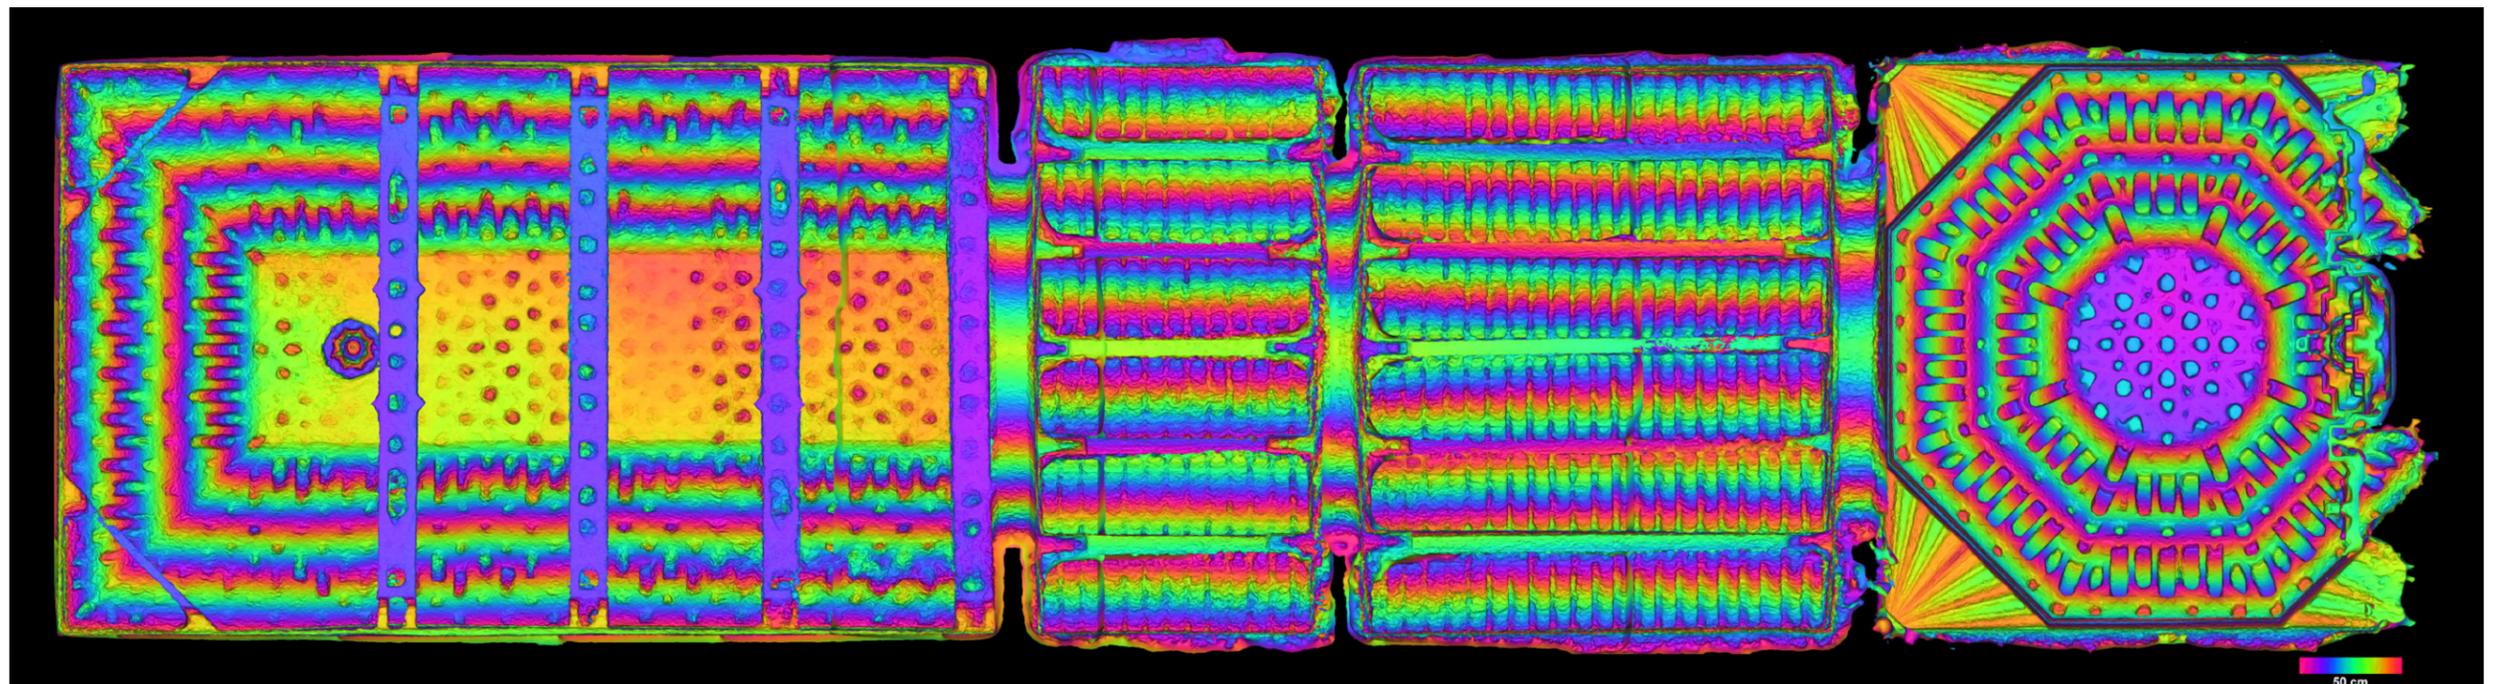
Plano de elevaciones sobre la nube de puntos obtenida de las armaduras de San Miguel Bajo.
